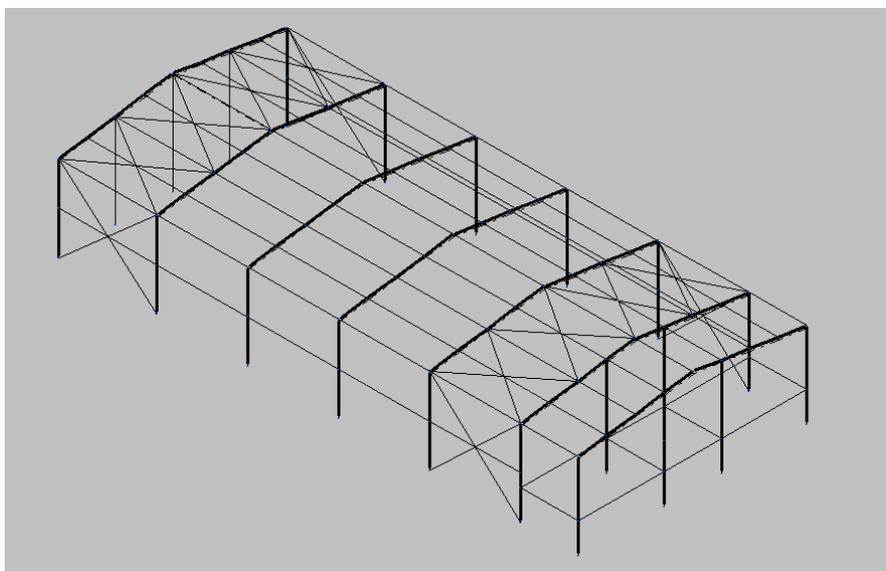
Estructura completa. Fuente: CYPE 2017
